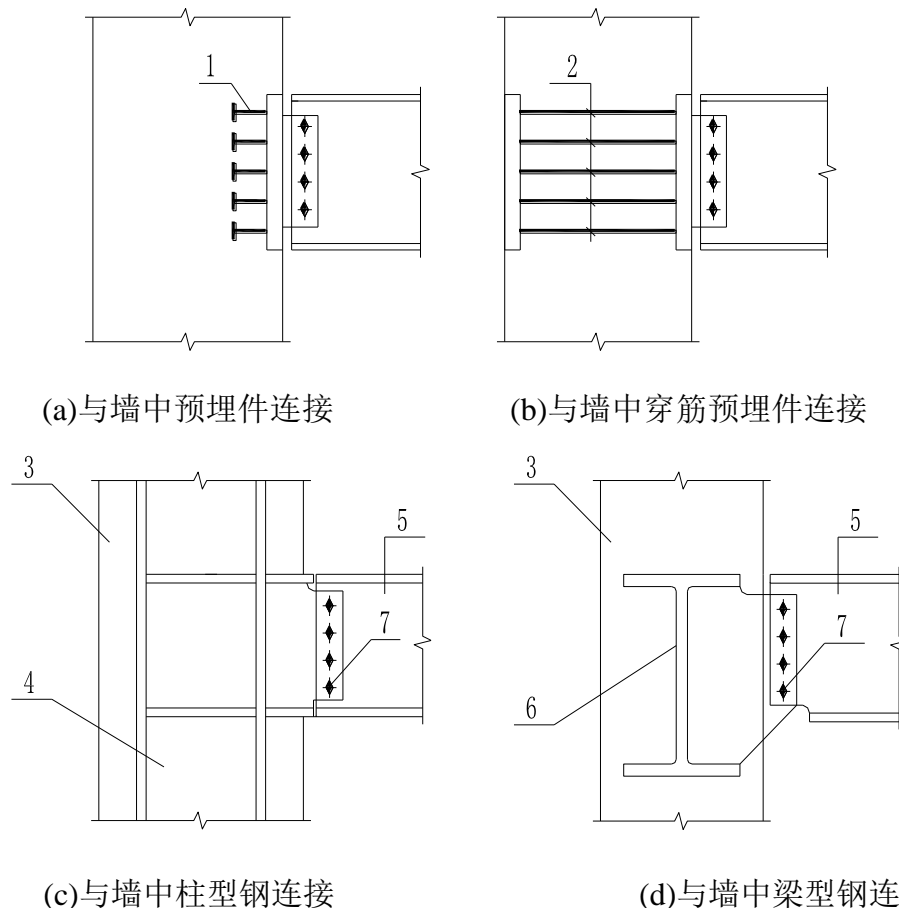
钢梁与钢筋混凝土墙的铰接
